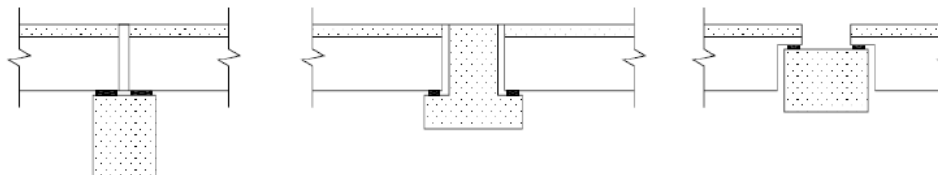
Alguns tipos de vigas pré-fabricadas [8]
